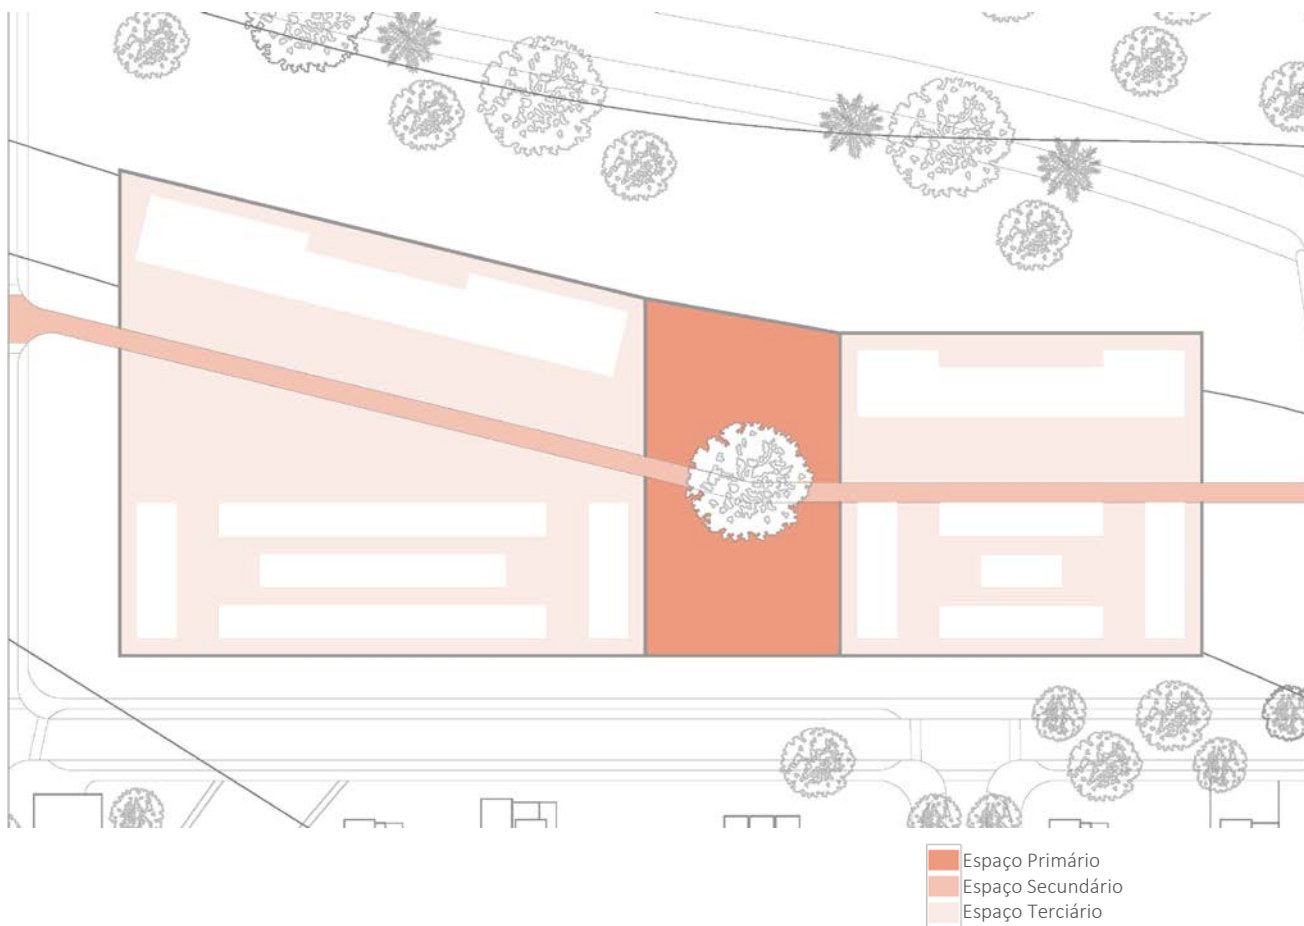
Planta esquemática dos espaços exteriores e de circulação
